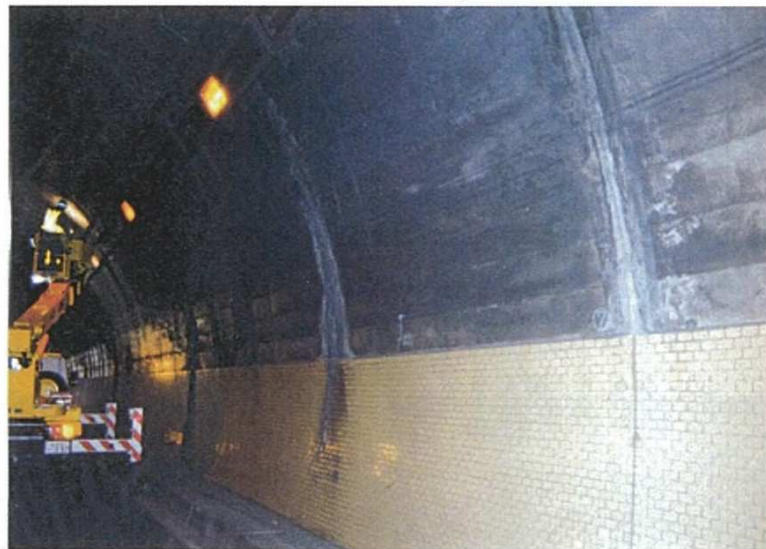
覆工スパンの中間付近に発生したひび割れの例
